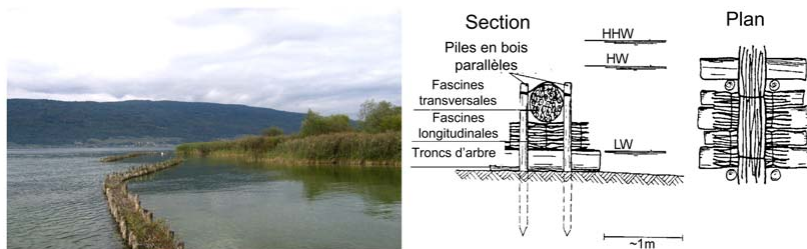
Implantation et construction des barrages à claire-voie sur le lac de Biemme
